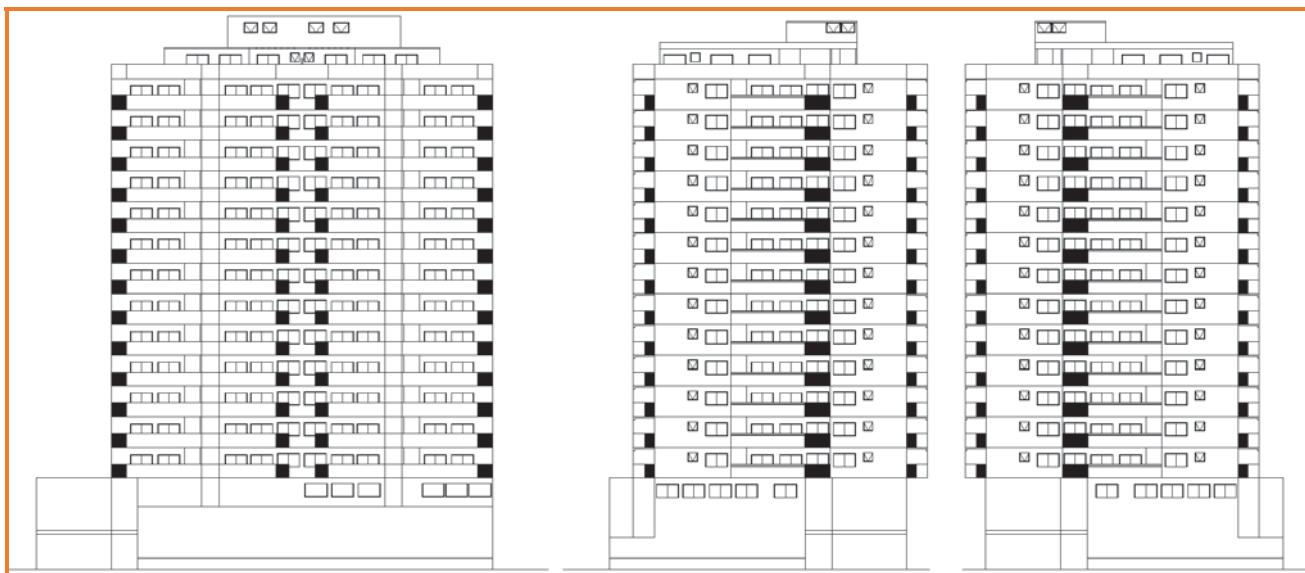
Fachadas: Trav. Paula Antunes, principal R. Mario Vianna e fundos para a Trav. Lucia - Fonte Projeto Legal
